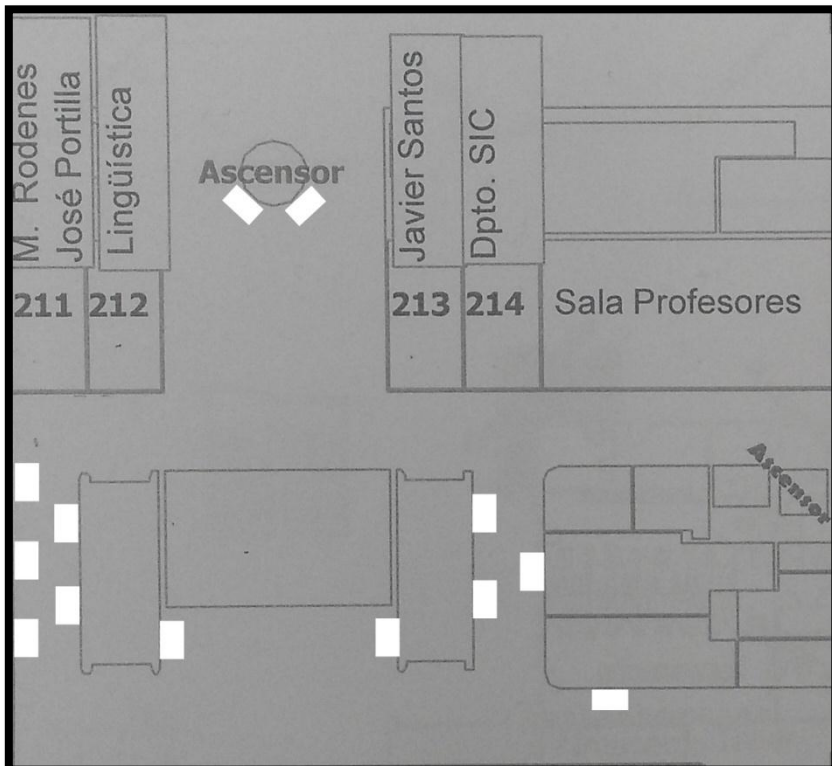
Plano de la segunda planta de la escuela con la disposición de las vitrinas.
